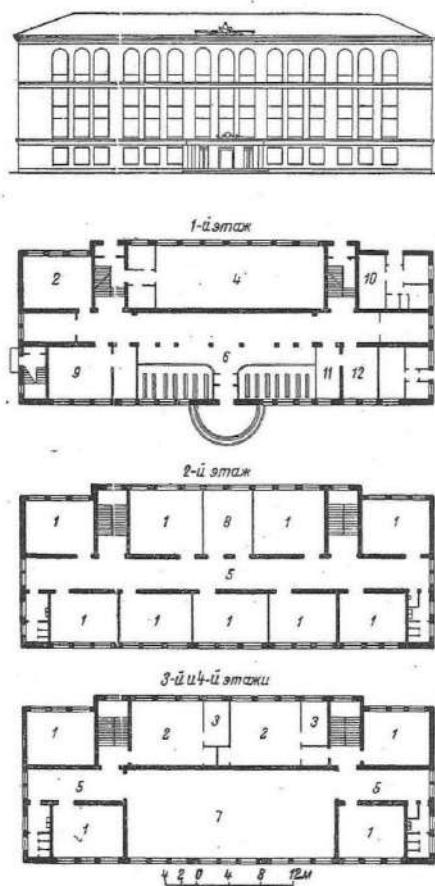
Типовой проект школы архитектора Л. А. Степановой, фасад — С. Д. Юсина, 1950 г. Фасад и планы этажей
